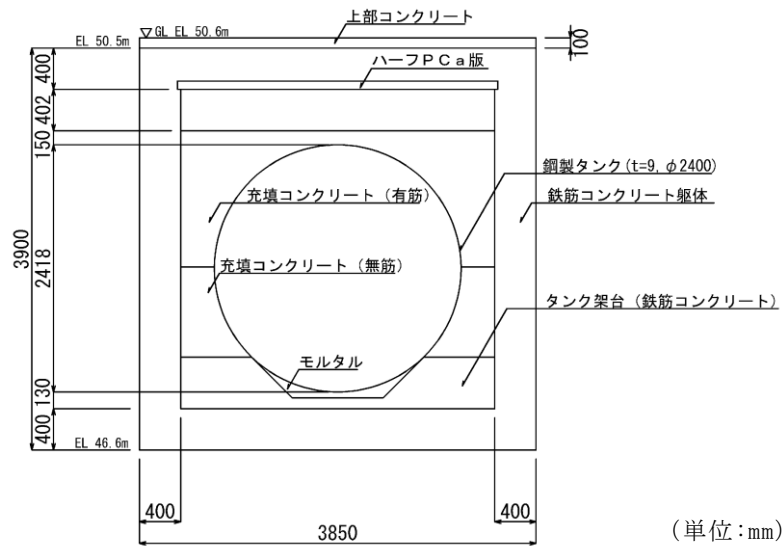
緊急時対策所用燃料地下タンク 断面図 (A-A断面)
